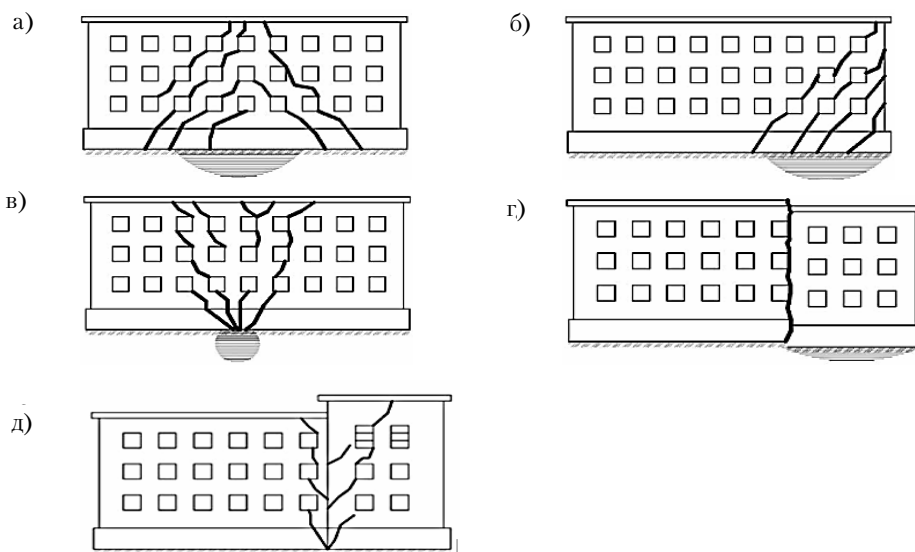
Схемы расположения трещин при неравномерной осадке зданий: а) наличие слабого грунта под средней частью зданий; б) то же у края здания; в) присутствие жесткой опоры в грунте под средней частью; г) осадка секции; д) разность уплотнения или давления на грунт под зданием.
